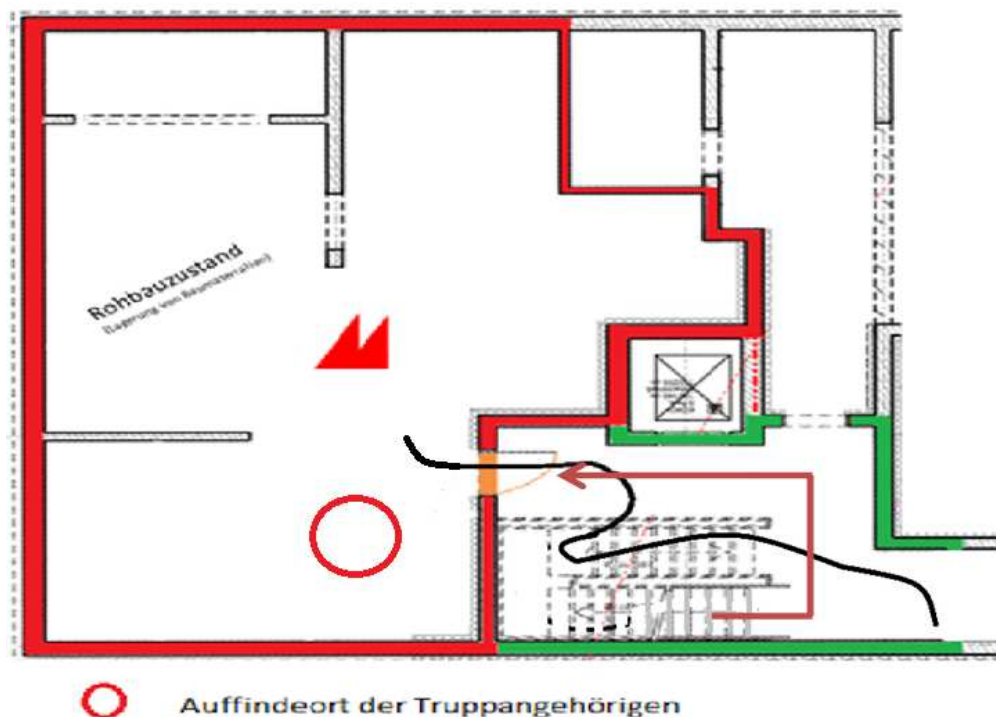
Grundriss des im Rohbauzustand befindlichen Kellergeschosses (Untergeschoss des Gebäudes). Der Hauptraum des Kellers wurde als Lagerfläche benutzt und war durch eine Bautür (orange) gesichert. Der Weg des Angriffstruppführers 1-1 vom Eingangsbereich über den Treppenraum ist durch den roten Pfeil gekennzeichnet, die verlegte Schlauchleitung [unter dem Treppengeländer auf direktem Weg] und Weg des Truppmann 1-1 in schwarz
